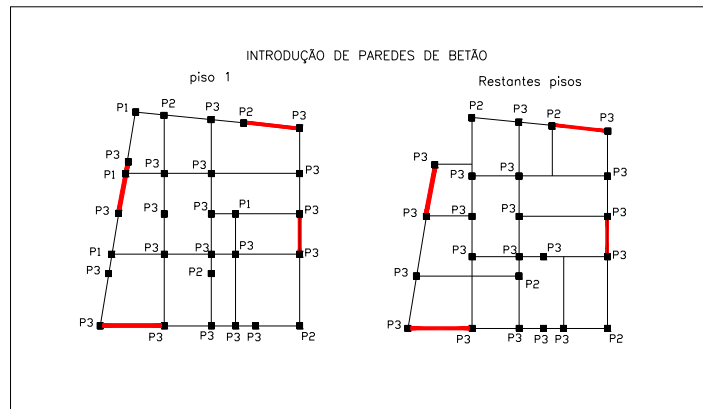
Planta estrutural do edifício reforçado com introdução de paredes de betão.
